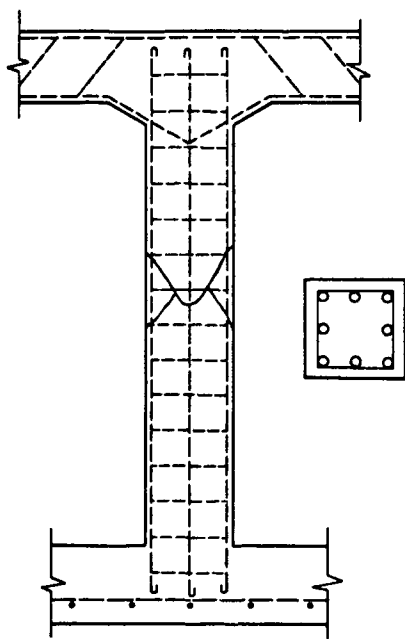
Columna comprimida con armadura simple. Grietas en el instante de la rotura, según Bukowski¹.
